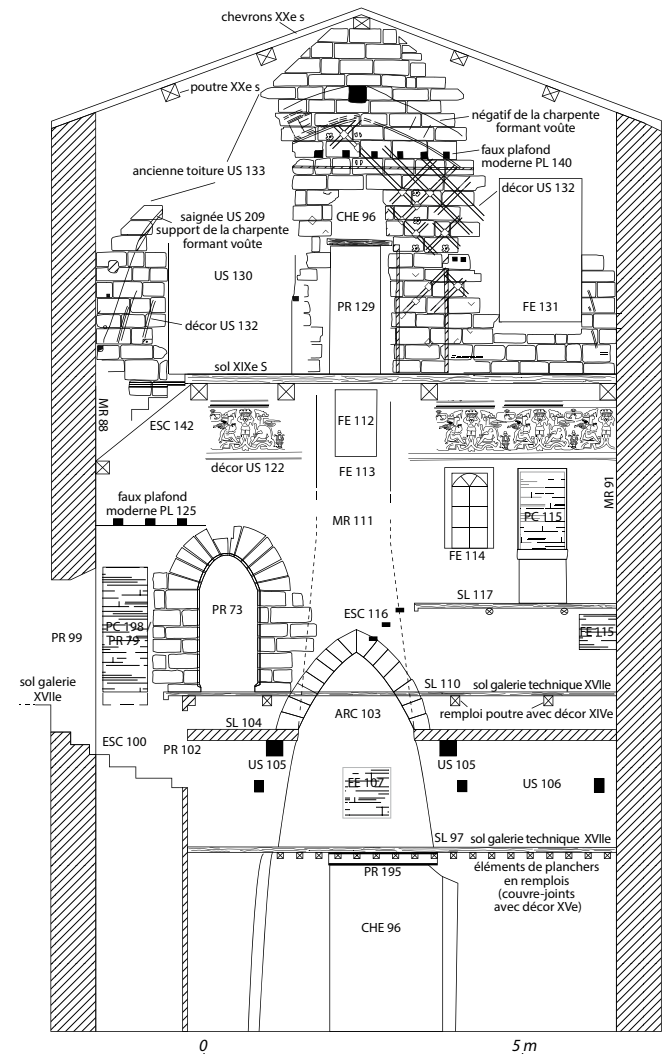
AVIGNON, hôtel du roi René. Grand tinel/chapelle ; mur pignon ouest : coupe sud-nord (DAO G. Baro / SADV).
